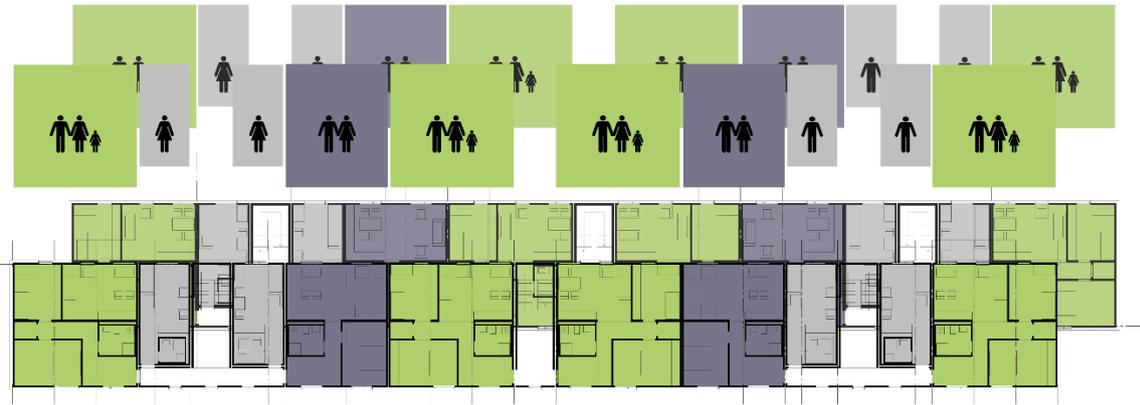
Grundriss eines Riegelbaus (aufgestockter Bereich)
